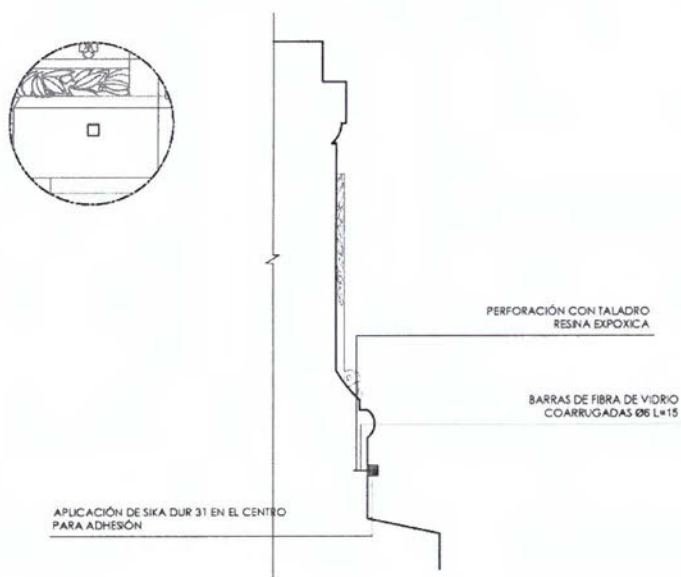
Elevación fachada sur, plano de detalle instalación ornamentos cúbicos. Fuente: Municipalidad de Providencia
